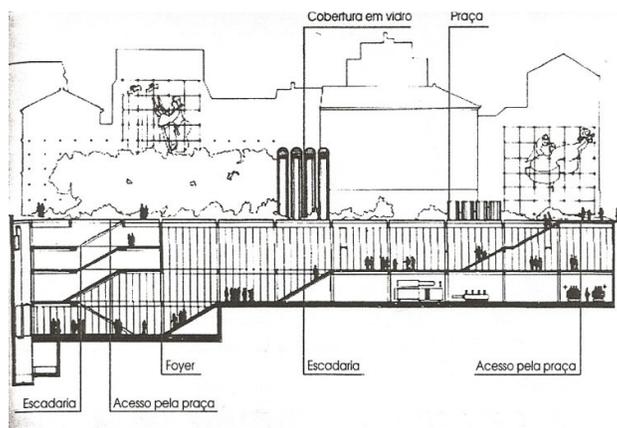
Corte longitudinal pelas áreas de acesso.
